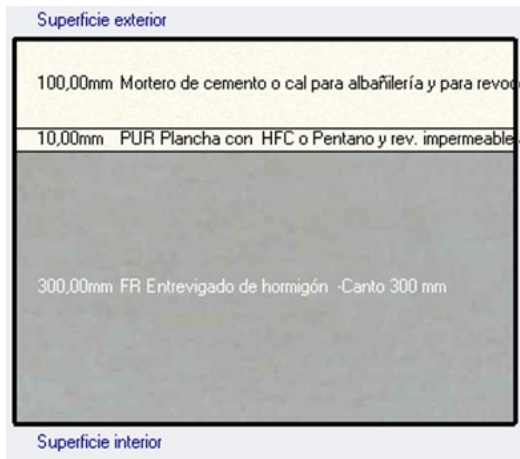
Cubierta en estudio. Tipo Cp-R1-b. Fuente: Design Builder.
